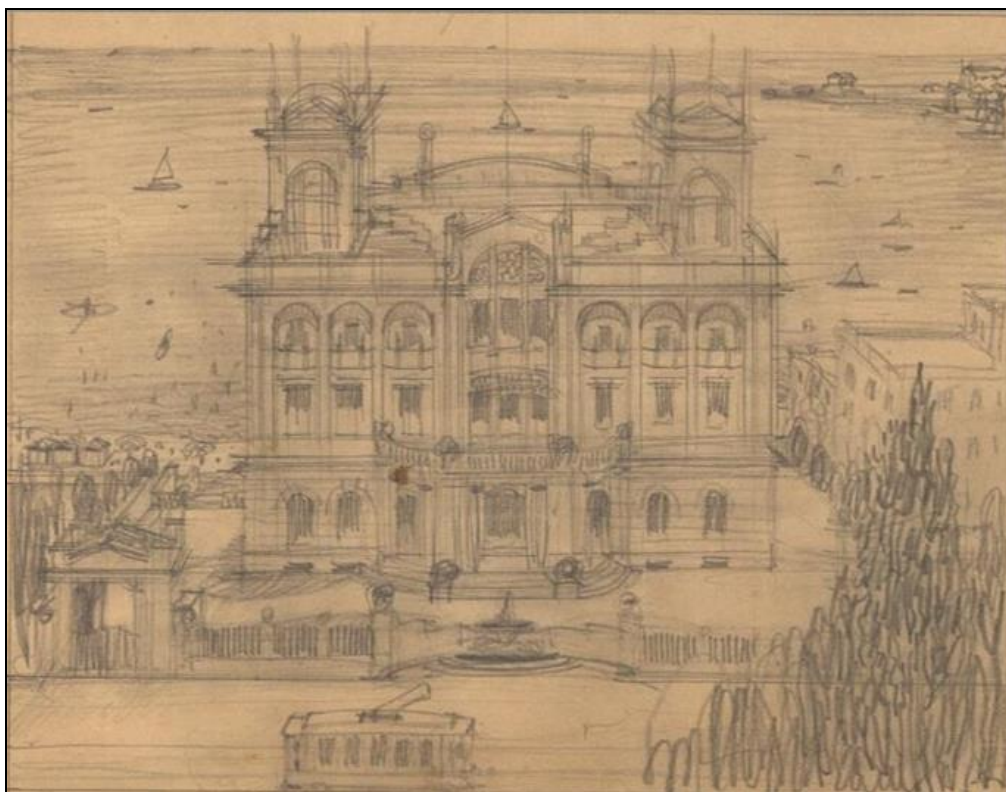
Studi assonometrici del complesso – Archivio di Stato di Terni (Fondo Bazzani)
